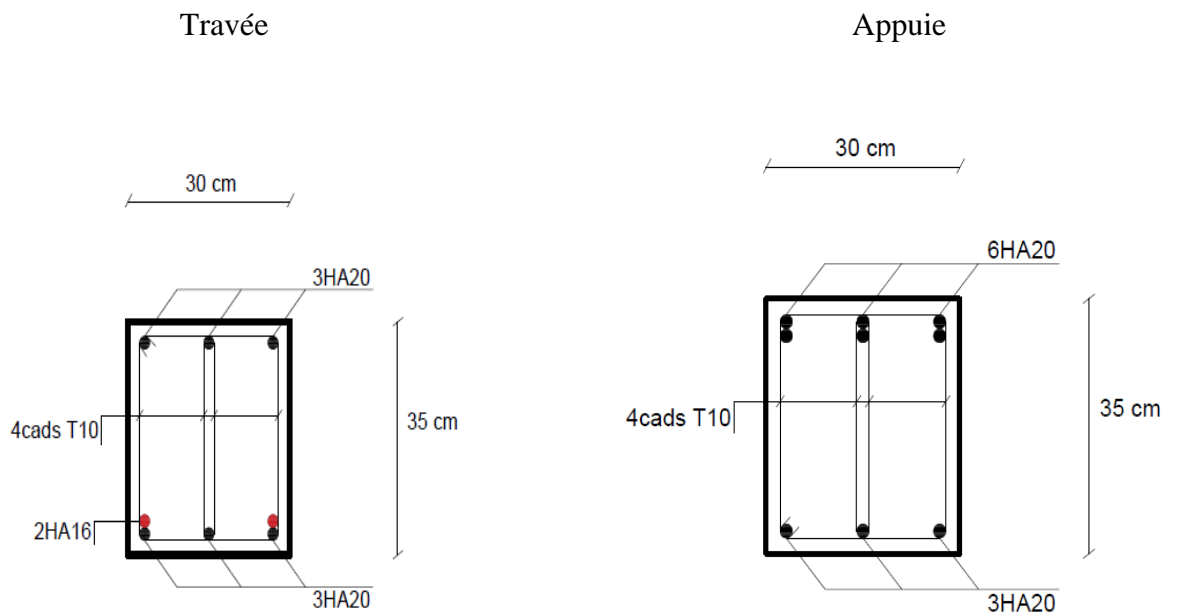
Schéma de ferrailage des poutres (35x30).
